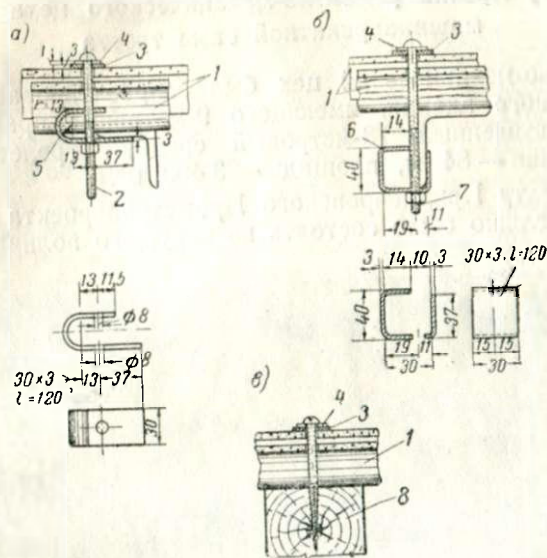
Детали крепления асбестоцементных волнистых плит: а — крепление плит к обрешетке; б — крепление плит у конька; в — крепление плит к деревянным прогонам обрешетки; 1 — асбестоцементные волнистые плиты; 2 — болт с гайкой диам. 6 × 100 мм; 3 — шайба из битуминированного асбестового картона диам. 25 × 3 мм, толщиной 3 мм; 4 — алюминиевая шайба диам. 20 × 1 мм; 5 — кляммера из полосового железа 30 × 3 мм; 6 — кляммера из полосового железа 30 × 3 мм; 7 — болт с гайкой диам. 6 × 160 мм; 8 — шуруп по дереву диам. 6 × 85 мм
